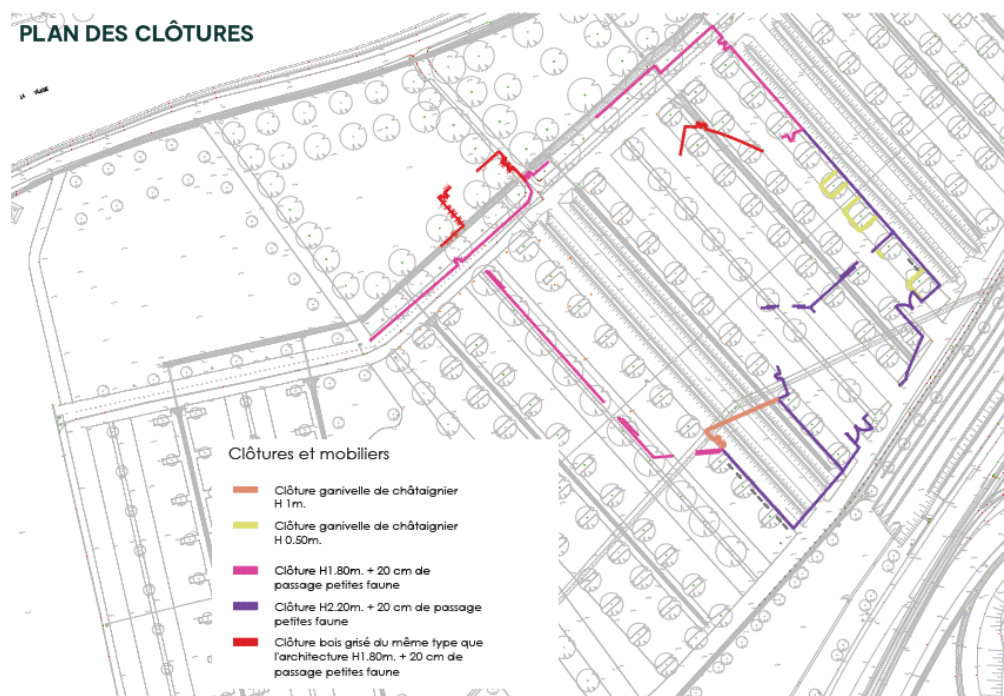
plan des clôtures et des principaux accès – source : LIAP – Mars 2024
